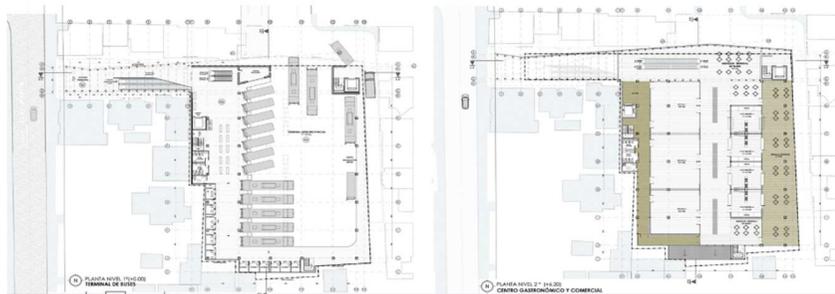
Plantas arquitectónicas Terminal de buses de Castro
